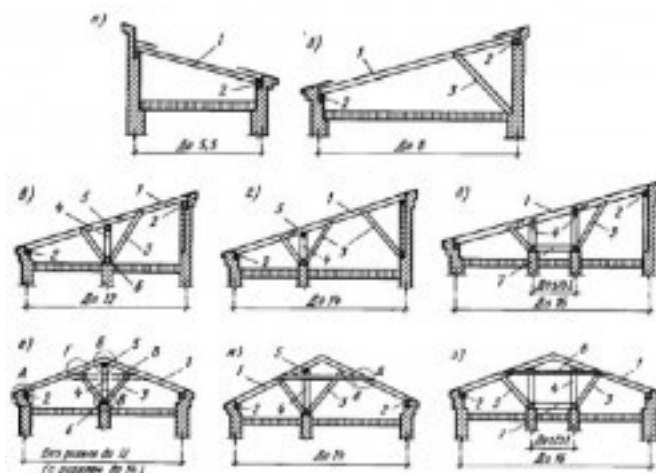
Конструктивные схемы крыш из деревянных наклонных стропил:
